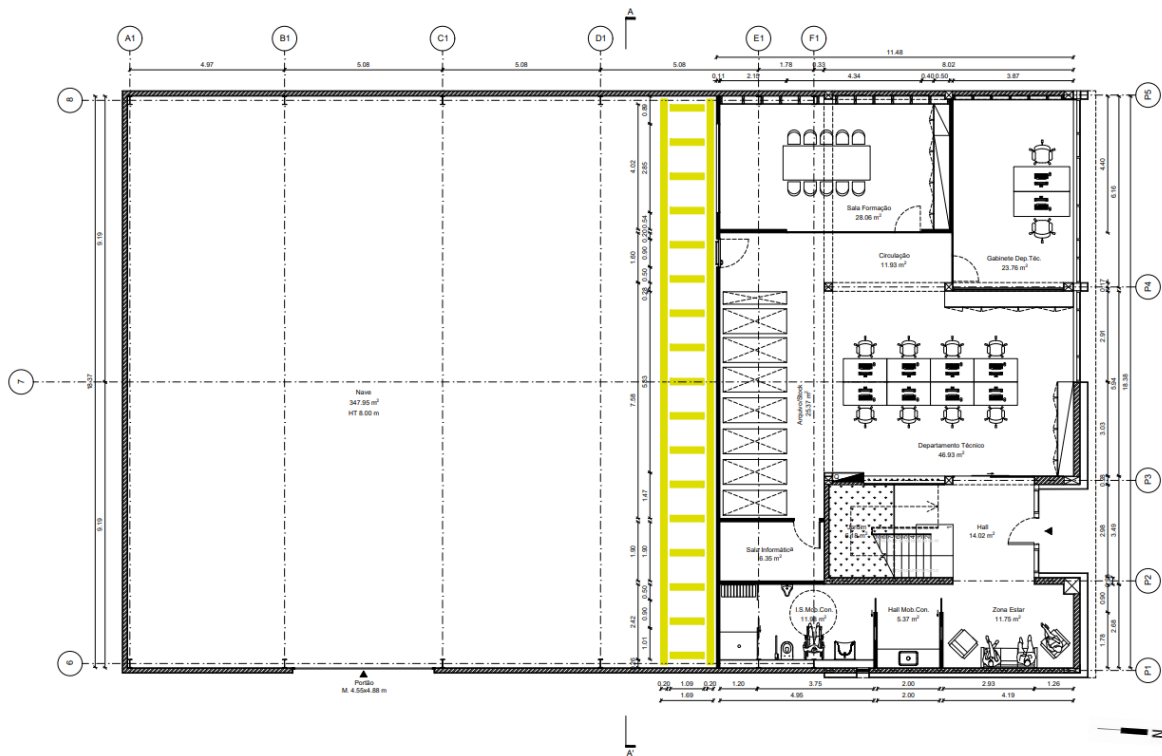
Proposto - Plantas do piso 0 (EXE_R00). Fonte: Garq / Desenvolvimento: Autora.
